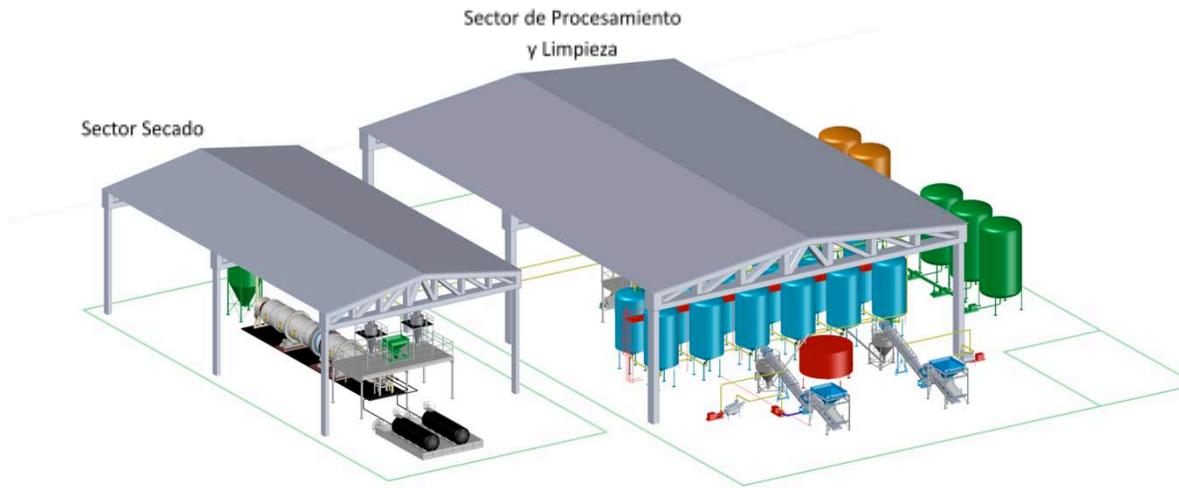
Vista de planta y galpón proyectado (Fuente: elaboración propia)
